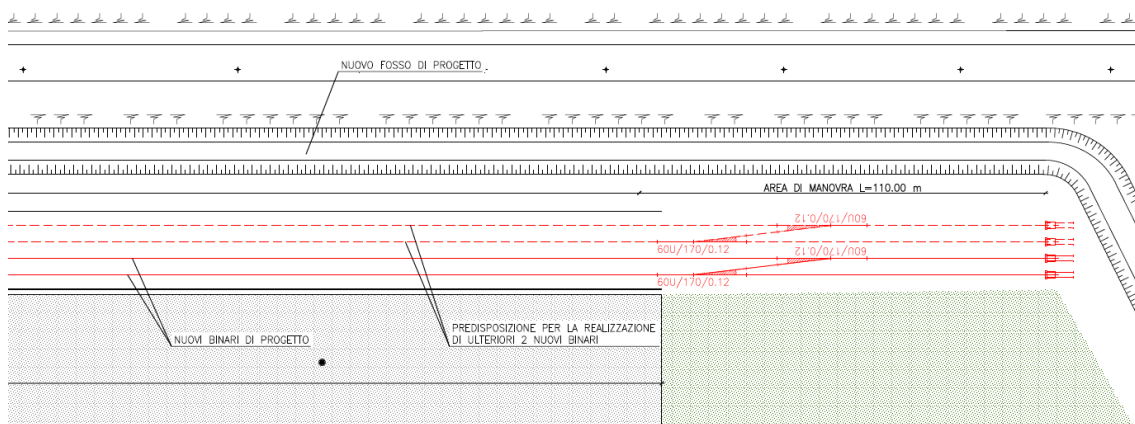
Estratto della planimetria di progetto con indicazione dei 4 binari realizzabili
